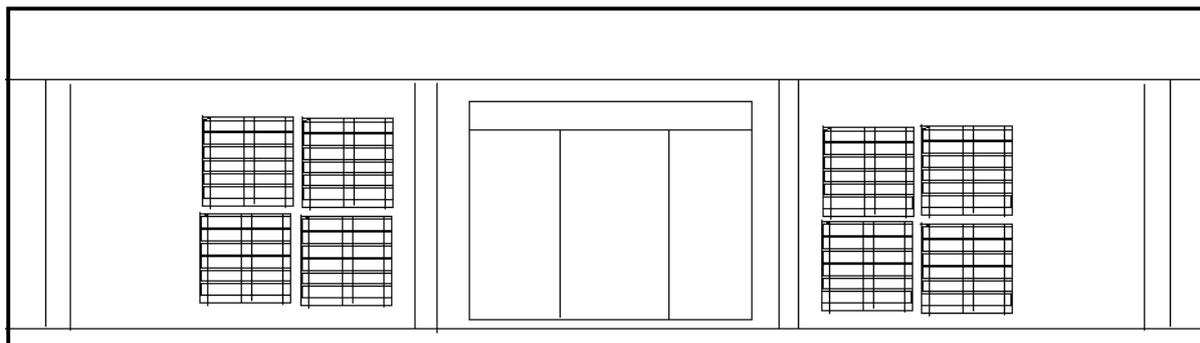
Modelos tipo treliça na fachada do IFPB.
